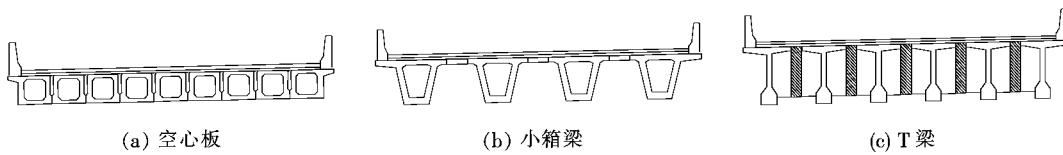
预应力混凝土空心板、箱形组合梁、T梁横断面图
